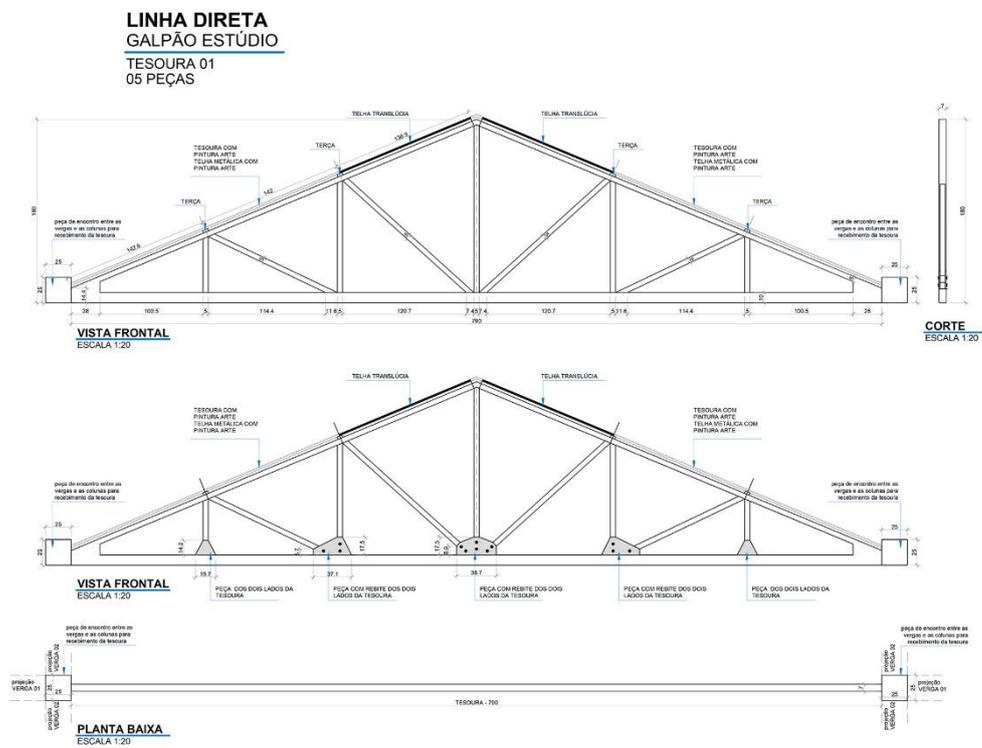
Desenho técnico – detalhamento das tesouras. Fonte: arquivo pessoal.
